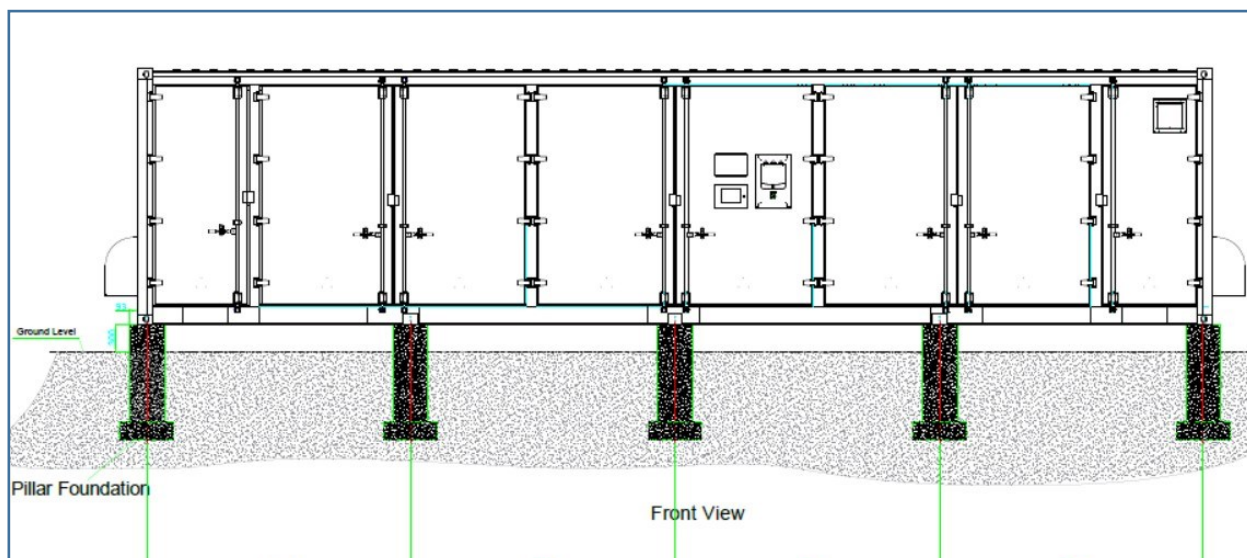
CABINATO PER BATTERIE (BESS) PROSPETTO PRINCIPALE
